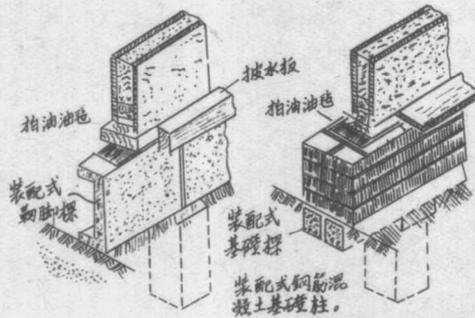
装配式鋼筋混凝土柱墩基礎，與装配式鋼筋混凝土勒脚樑及基礎樑凍結。
